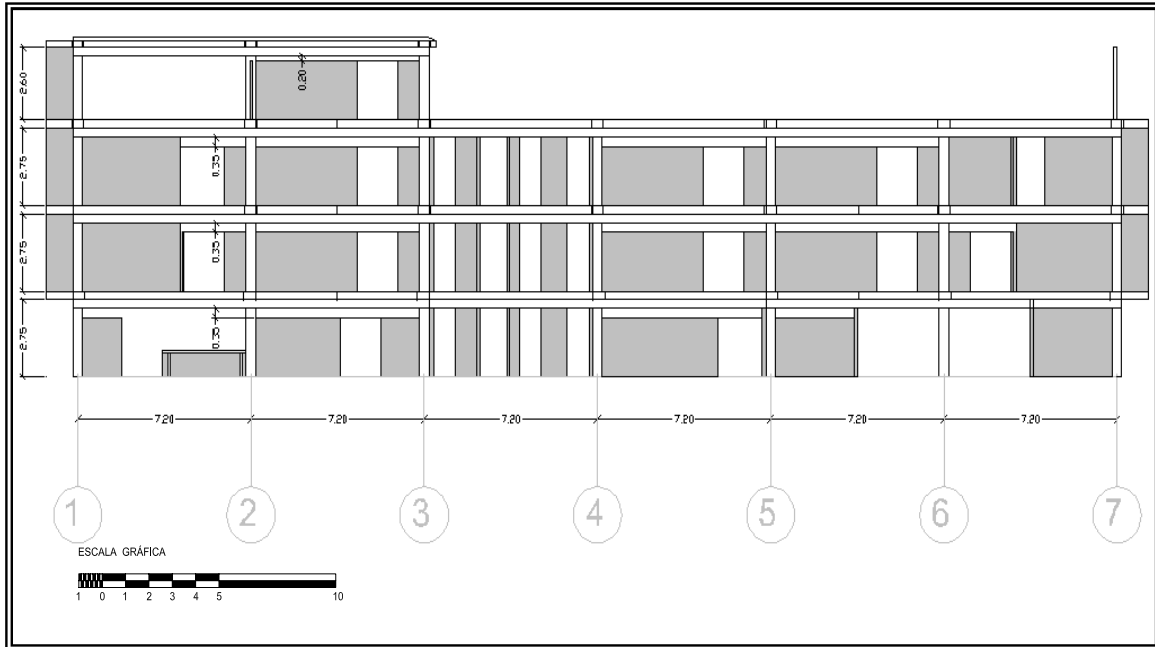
Pórtico E (este-oeste) mostrando las paredes de mampostería y la longitud efectiva de columnas
